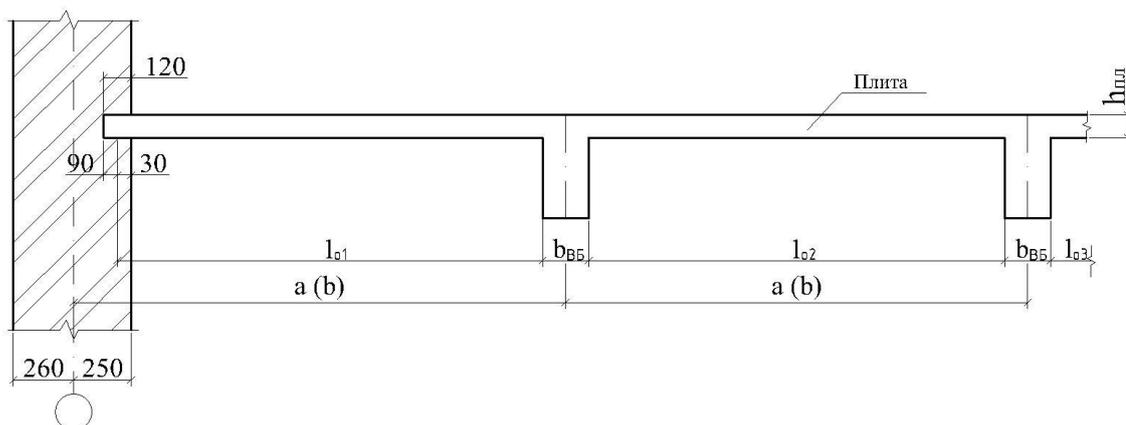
К назначению расчетных пролетов монолитной плиты перекрытия
